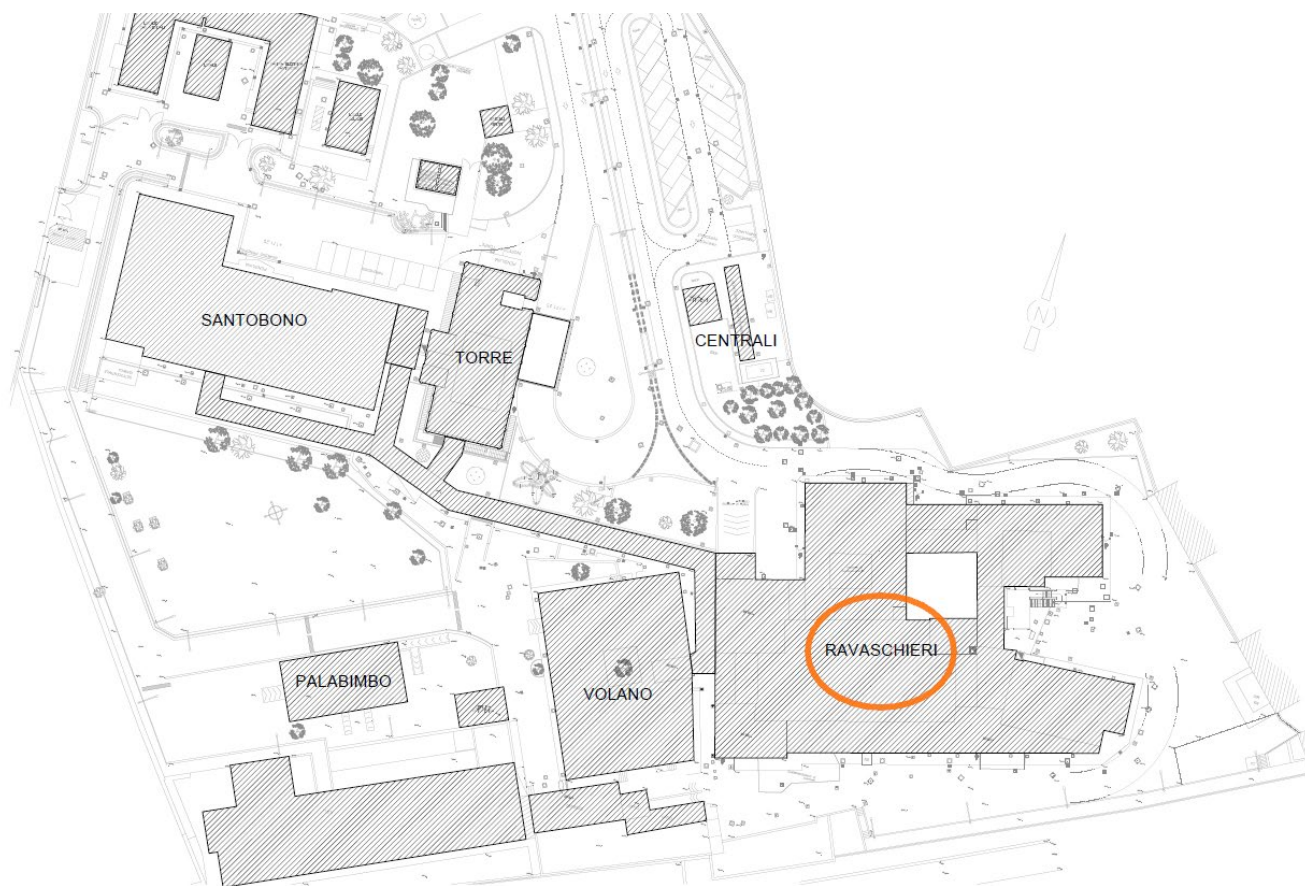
Planimetria generale dell'area con individuazione Pad. Ravaschieri
